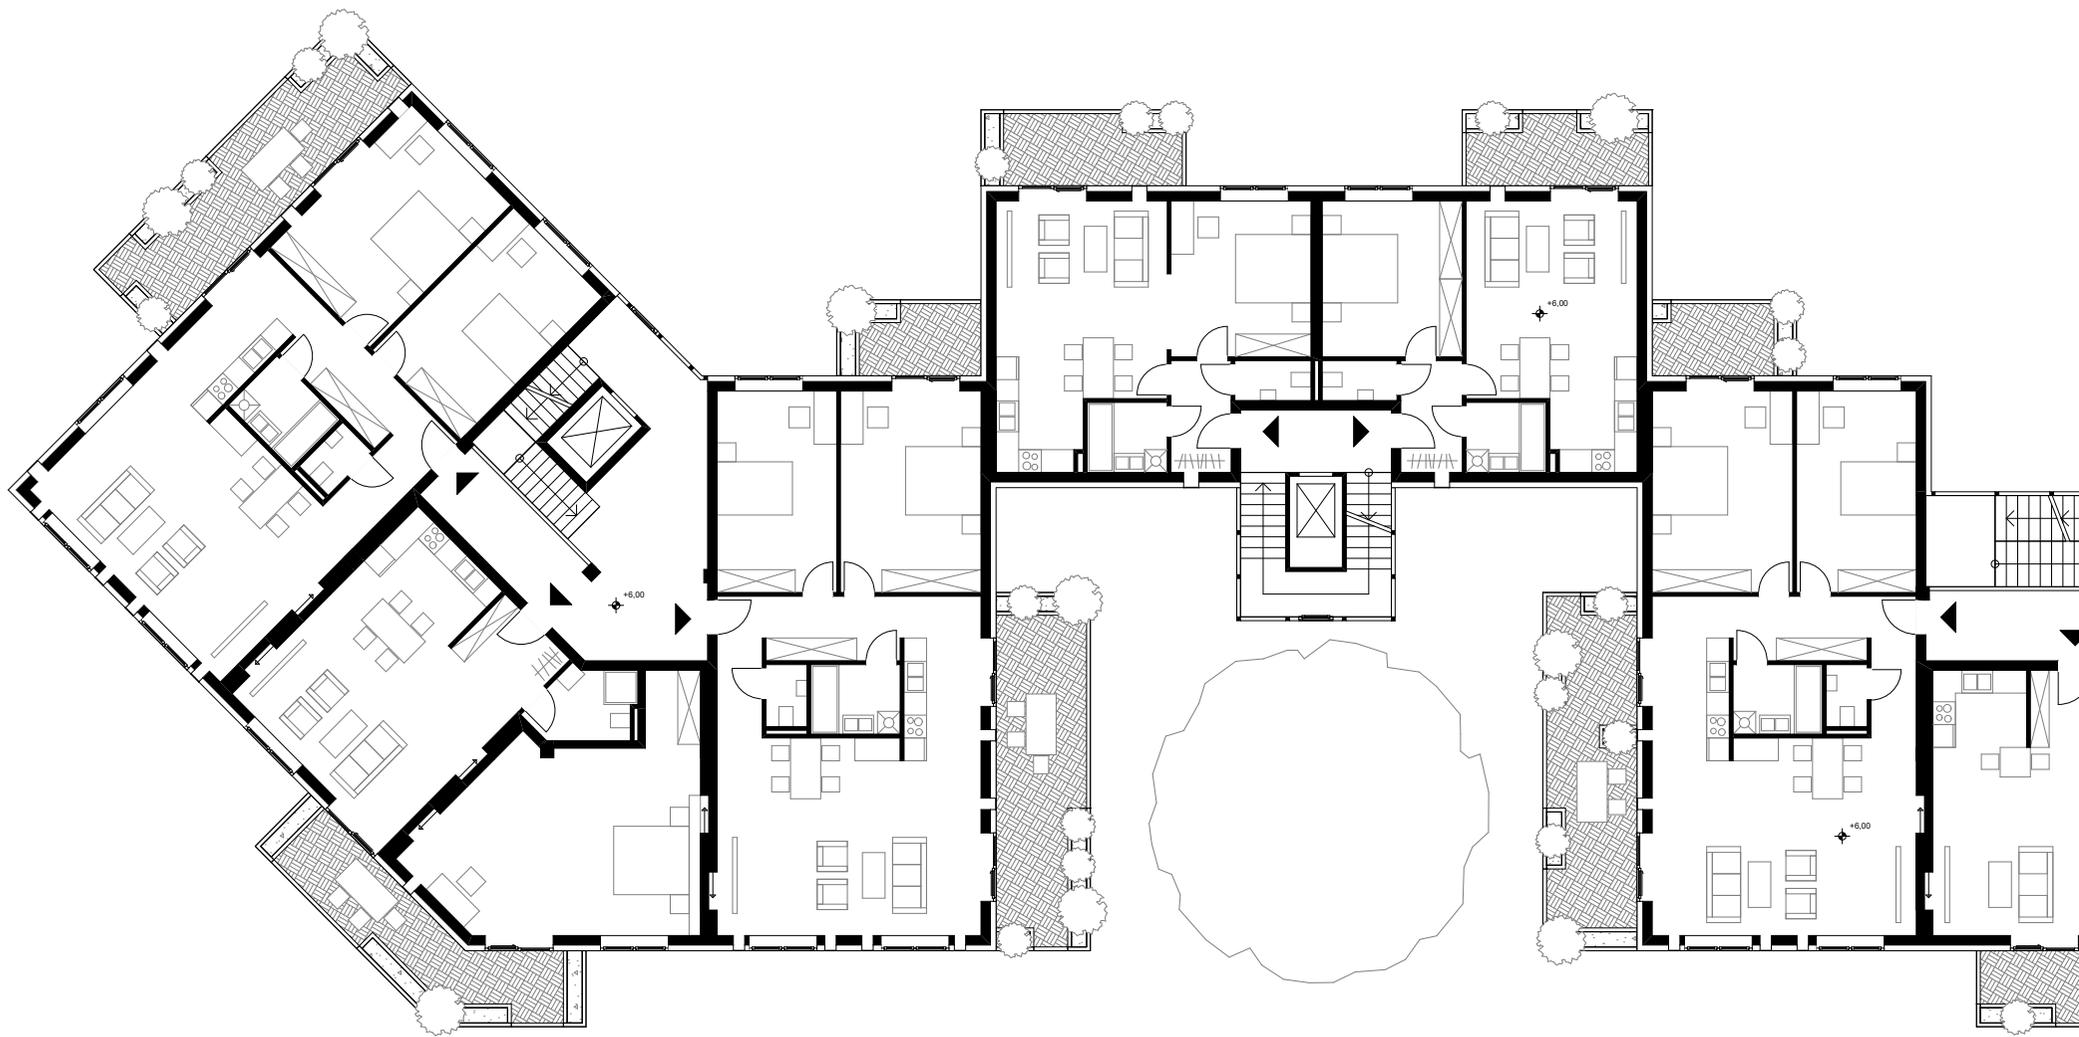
Grundriss 1.Obergeschoss - M 1:200
